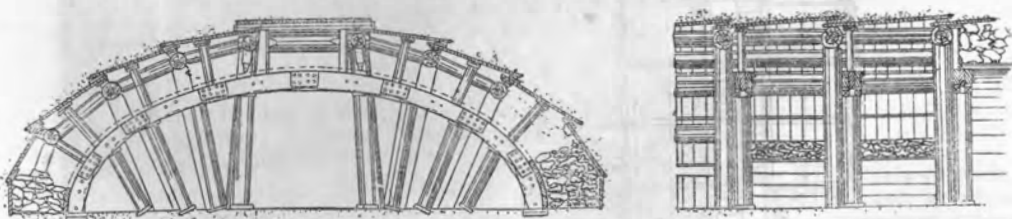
Возведение свода от пят к замку из бутовой кладки.
